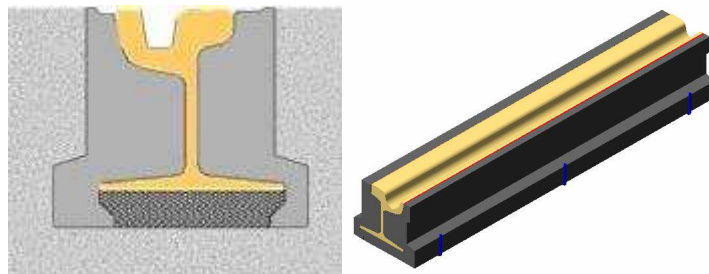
Elementos elastómeros para encapsulado del carril (técnica del “prechaquetado”)
